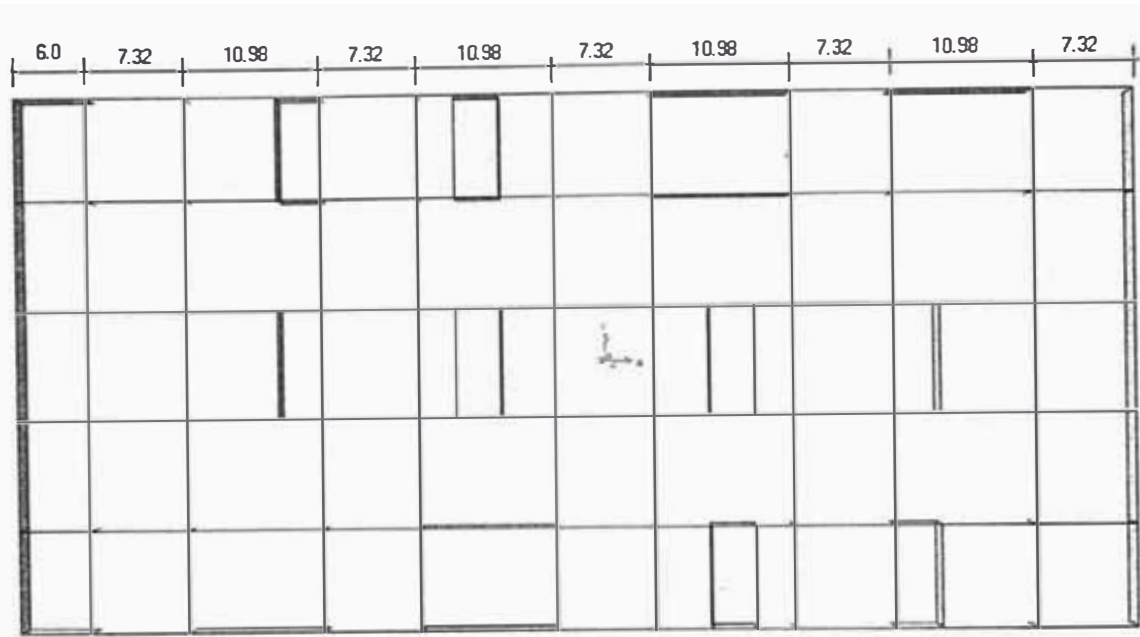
Planta típica - nivel sótano 2 a arenales
